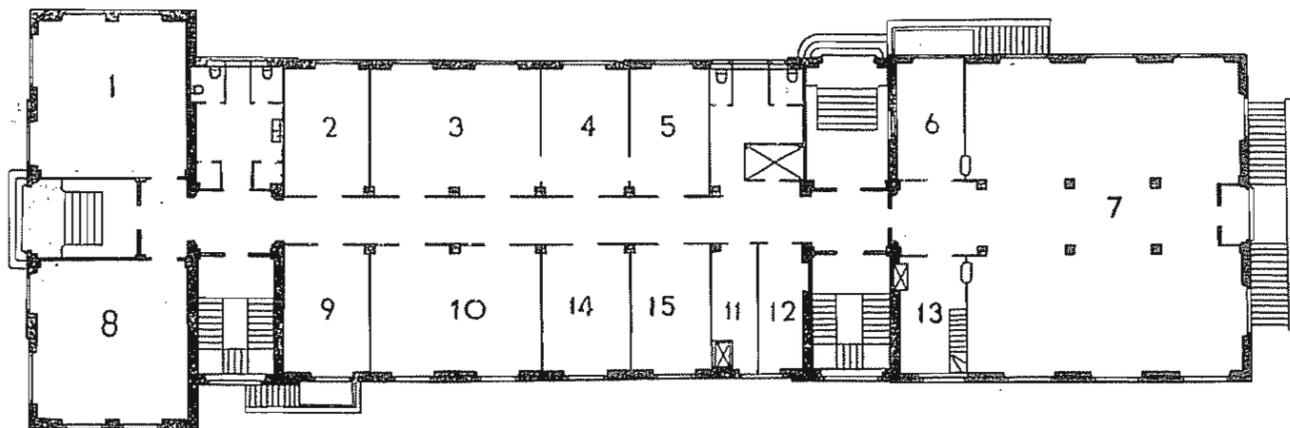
PADIGLIONE CONVITTO INFERMIERE DIPLOMATE - PIANTA DEL PIANO RIALZATO
